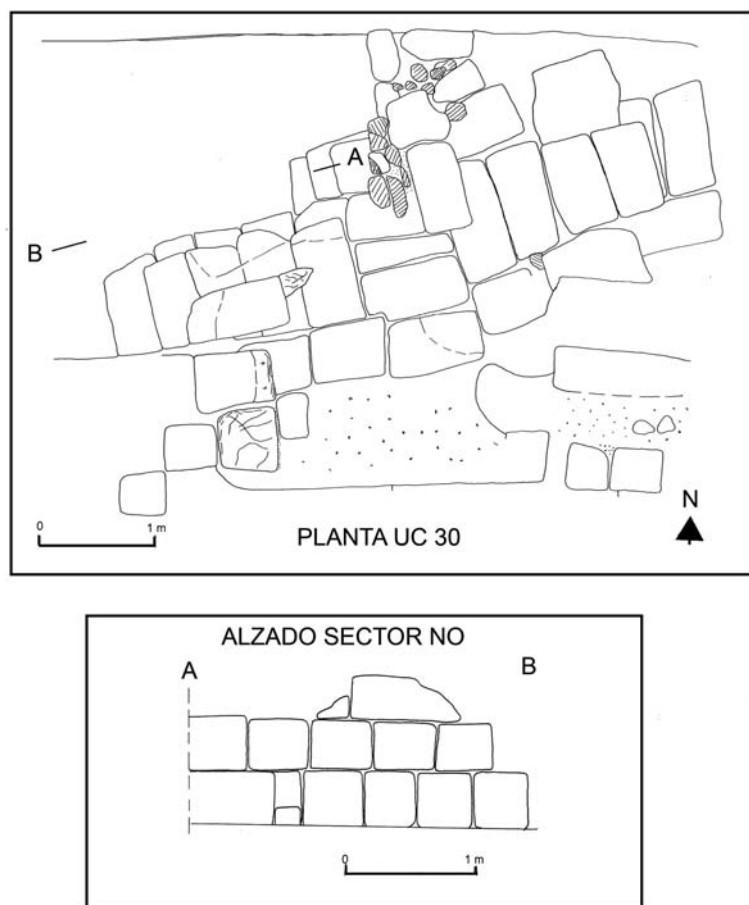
Planimetría y alzado de la unidad constructiva 30.
